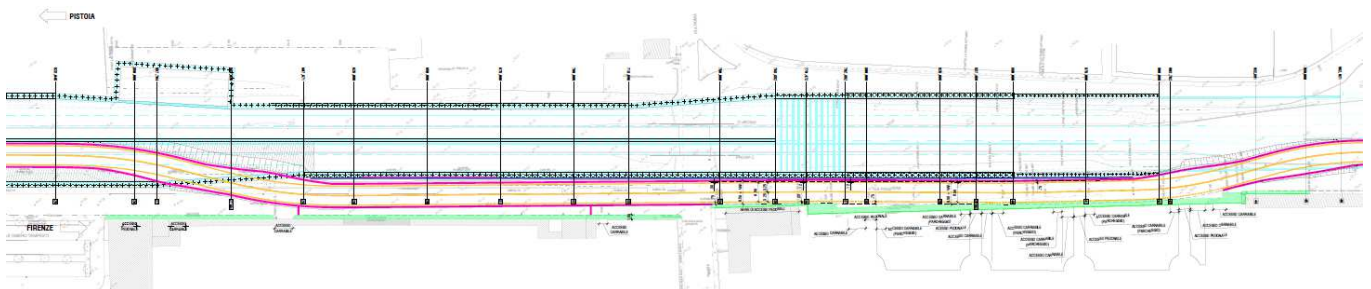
Planimetria deviazione provvisoria Fase 3 (parte 2)
